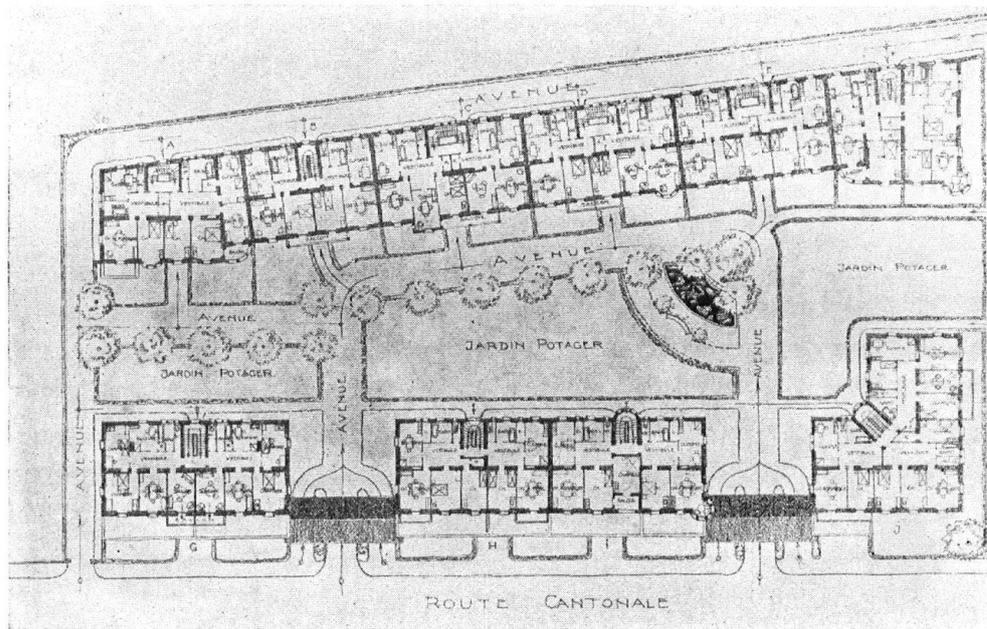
Projet „Sunlich“. Plan. — *Abb. 6.* Entwurf „Sunlich“. Plan.
